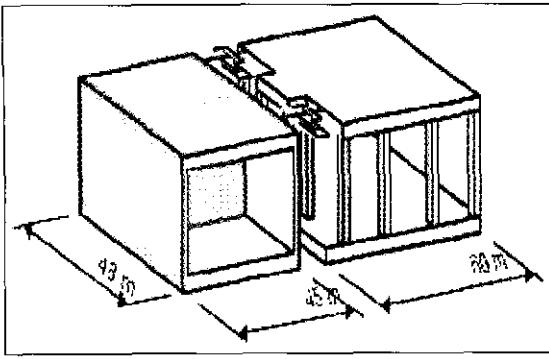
GIGA급 SSS(Smart Structure System) 개념도
